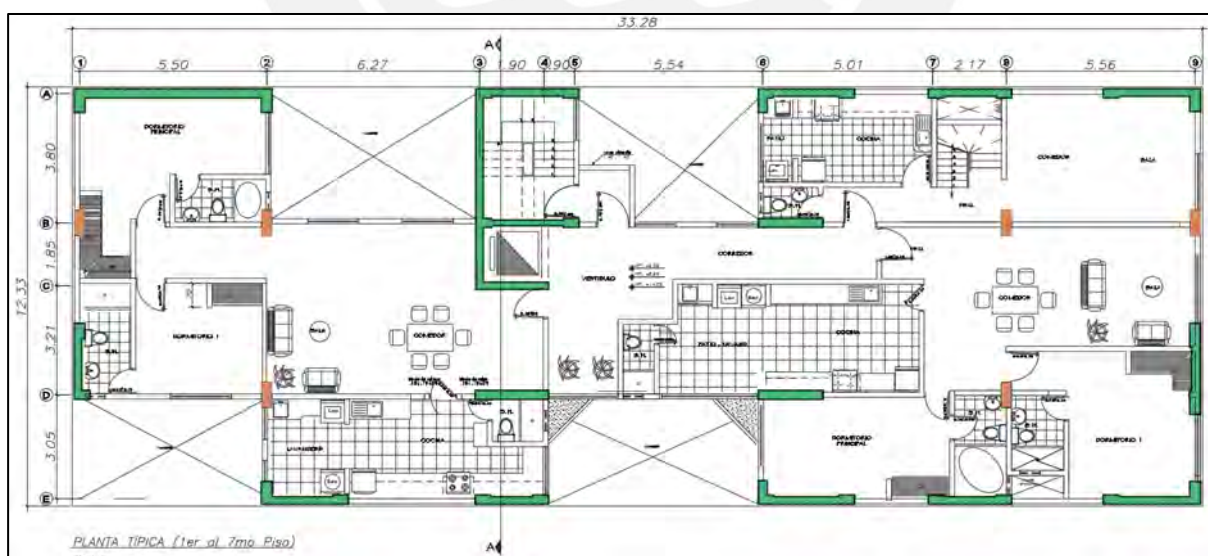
Plano de Arquitectura - Planta típica 2do, 4to y 6to nivel, escala 1/50 con elementos estructurales resaltados.
